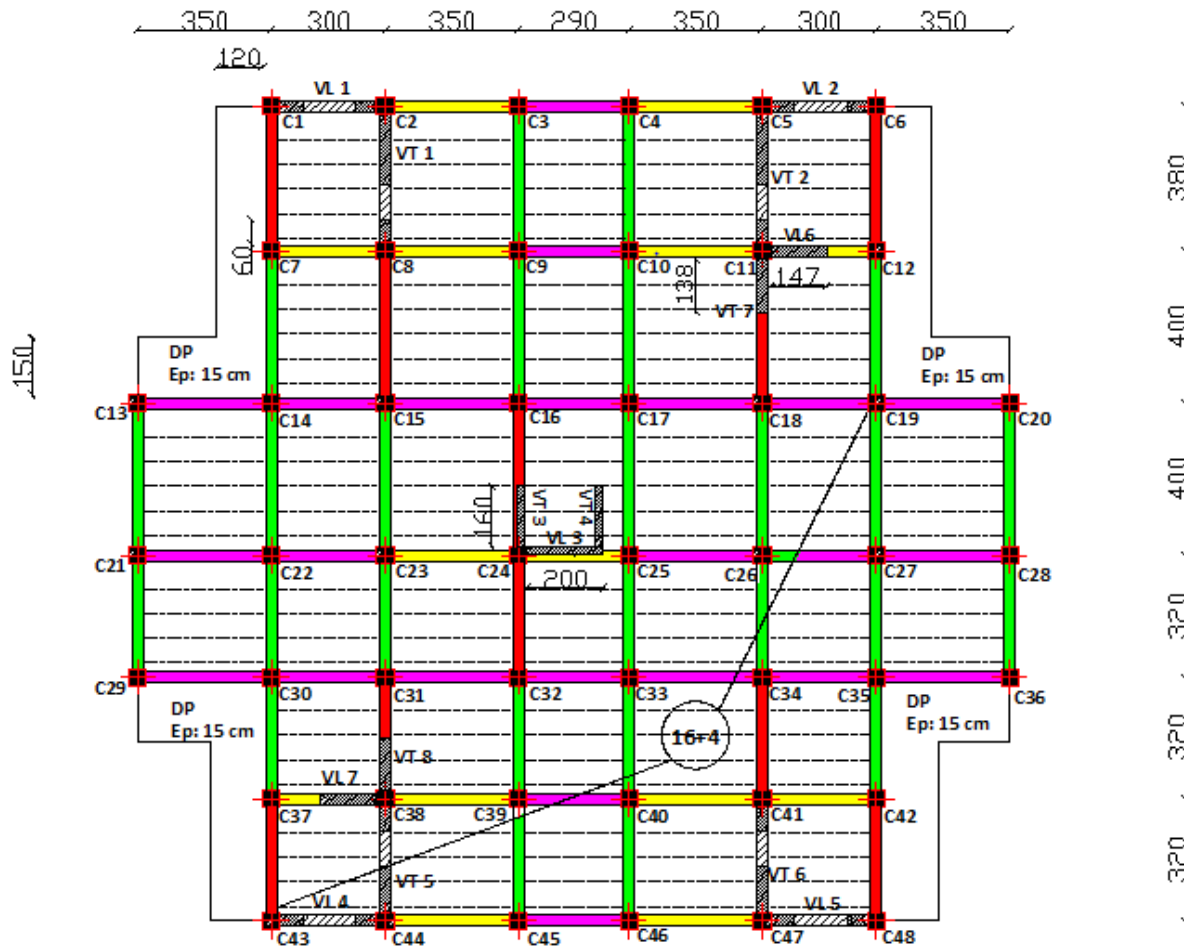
Groupe des poutres pour le ferrailage de la quatrième variante
